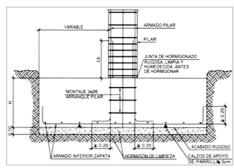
Detalle de Zapata Aislada Fuente: Investigación
